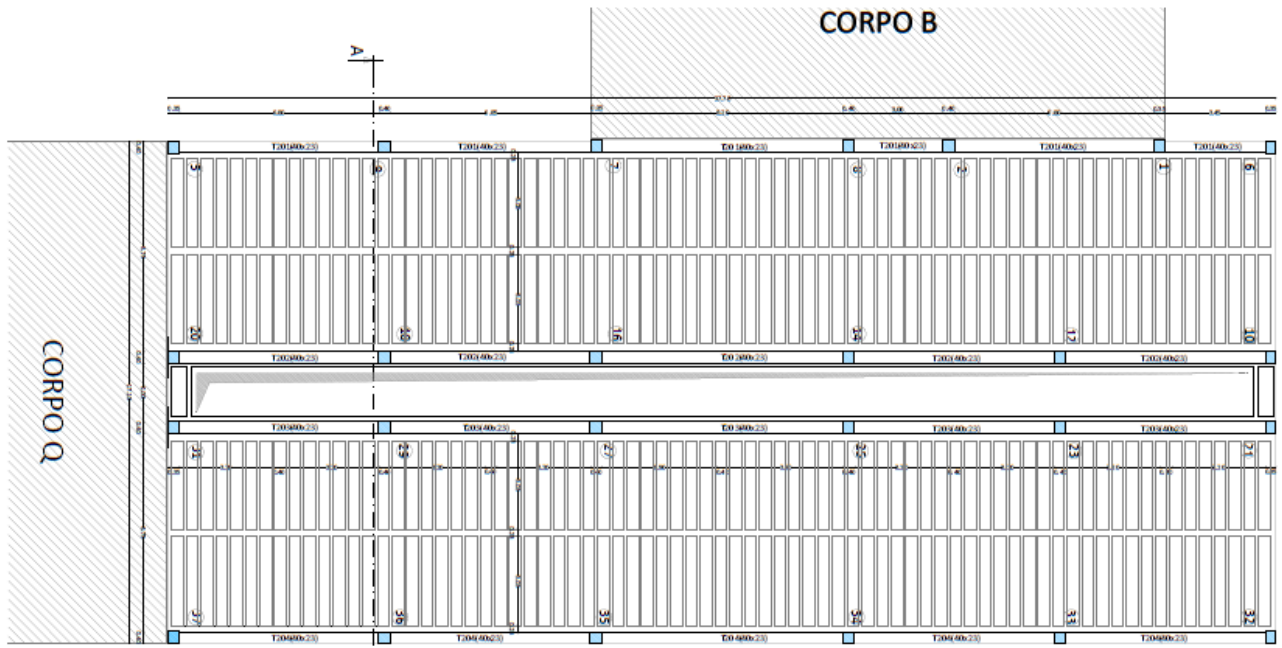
Blocco A - Planimetria Struttura Piano Copertura.
